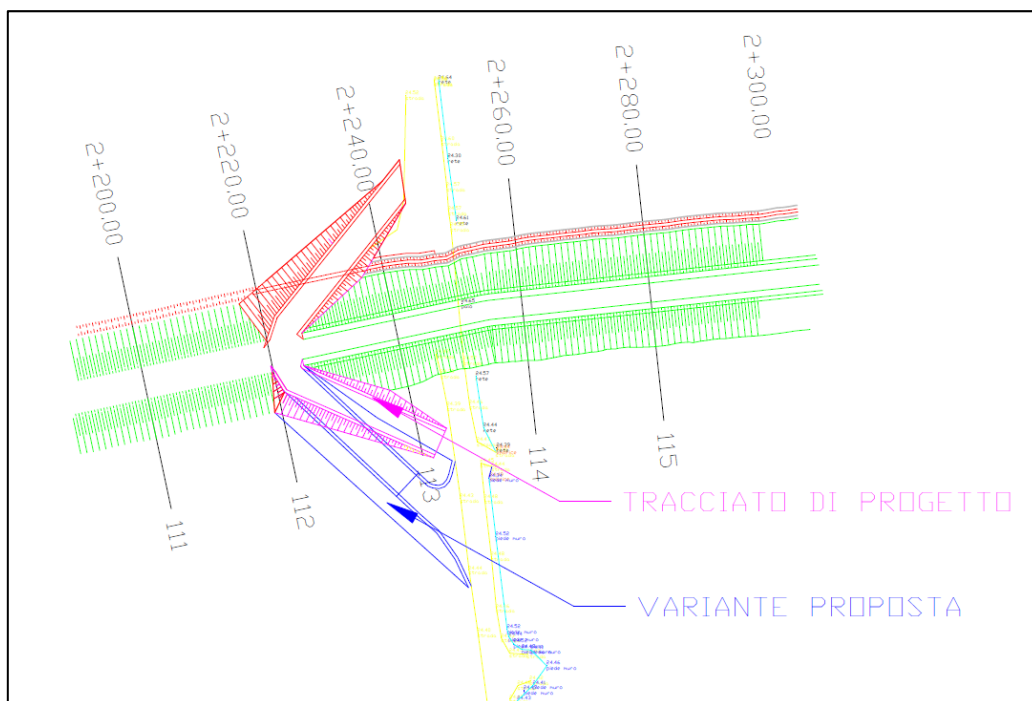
Planimetria di variante argine Comune di Capena, accesso 3
